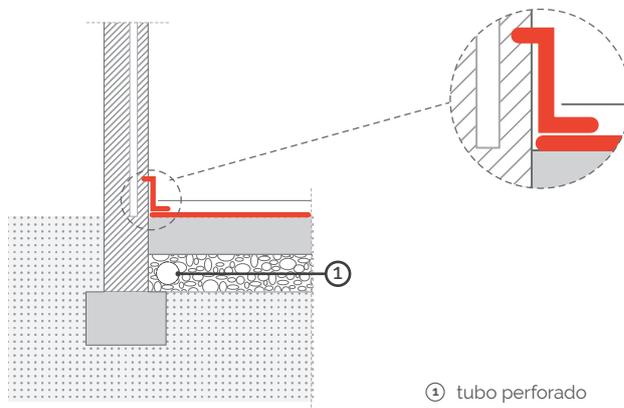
Encuentro de la barrera tipo lámina con una fachada mediante encastrado y tubo perforado
